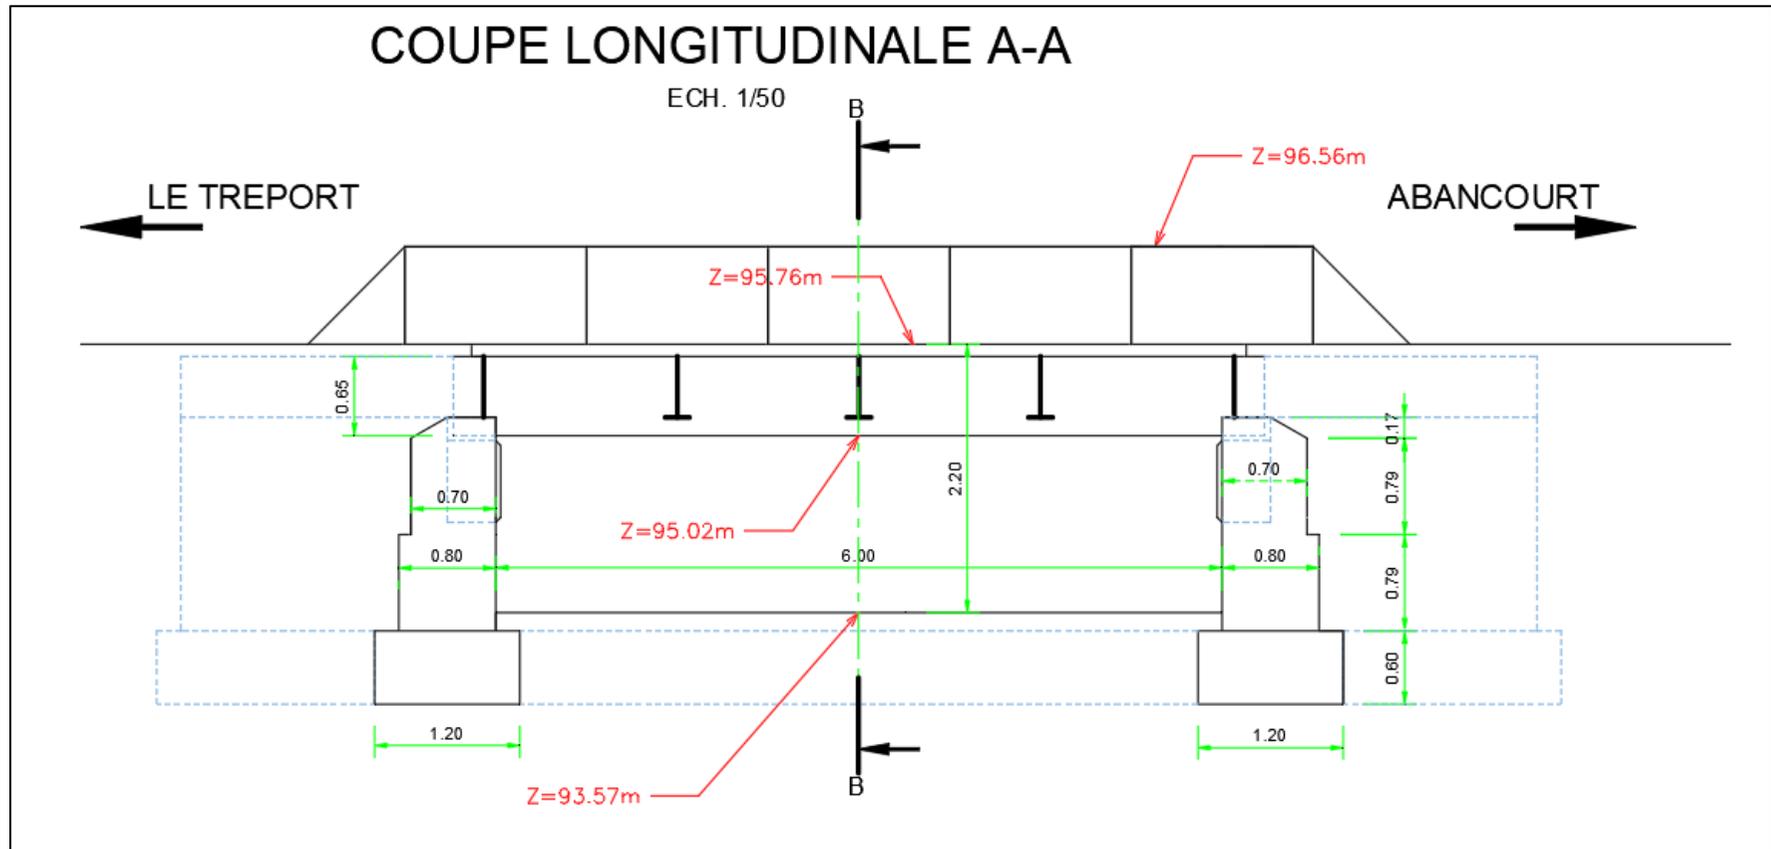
Coupe longitudinale du tablier existant du PRa situé au PK 142+268
